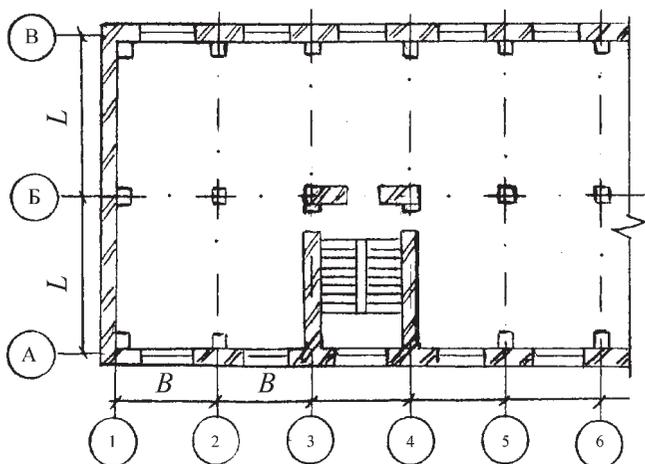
Габаритная схема многоэтажного здания с неполным каркасом (с железобетонными колоннами каркаса и кирпичными несущими стенами): B – шаг; L – пролет
